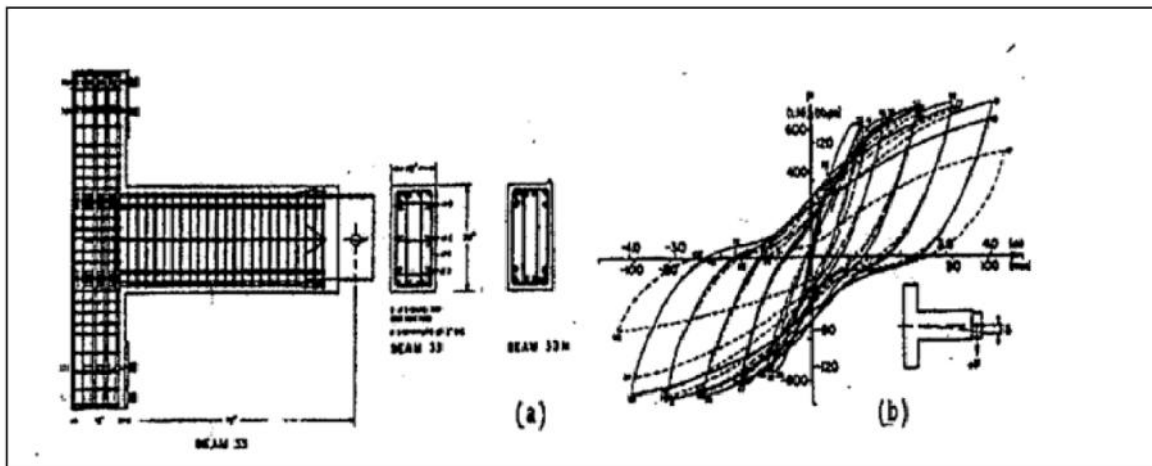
(a) poutre ferrailée normalement ; (b) boucles d'hystérésis.
